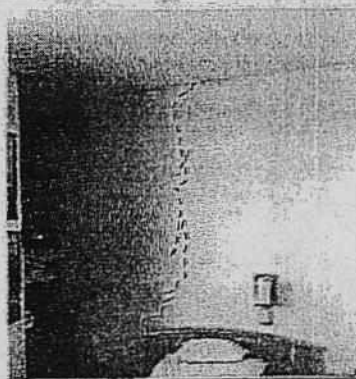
Fisuras en muro interior apartamento 501 torre costado norte.
